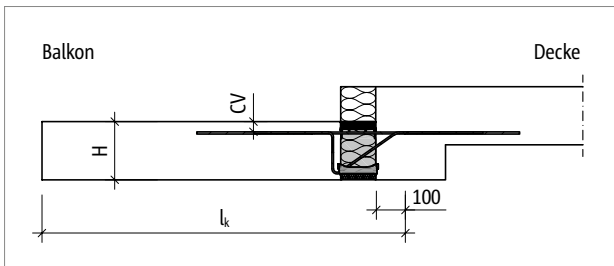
Schöck Isokorb® XT Typ KL-M1 bis M8: Statisches System
